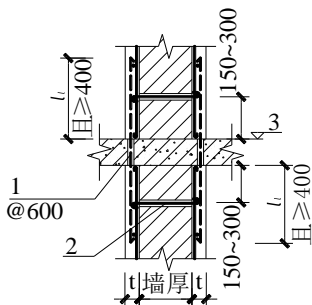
楼板处集中配置穿板连接筋做法示意图
